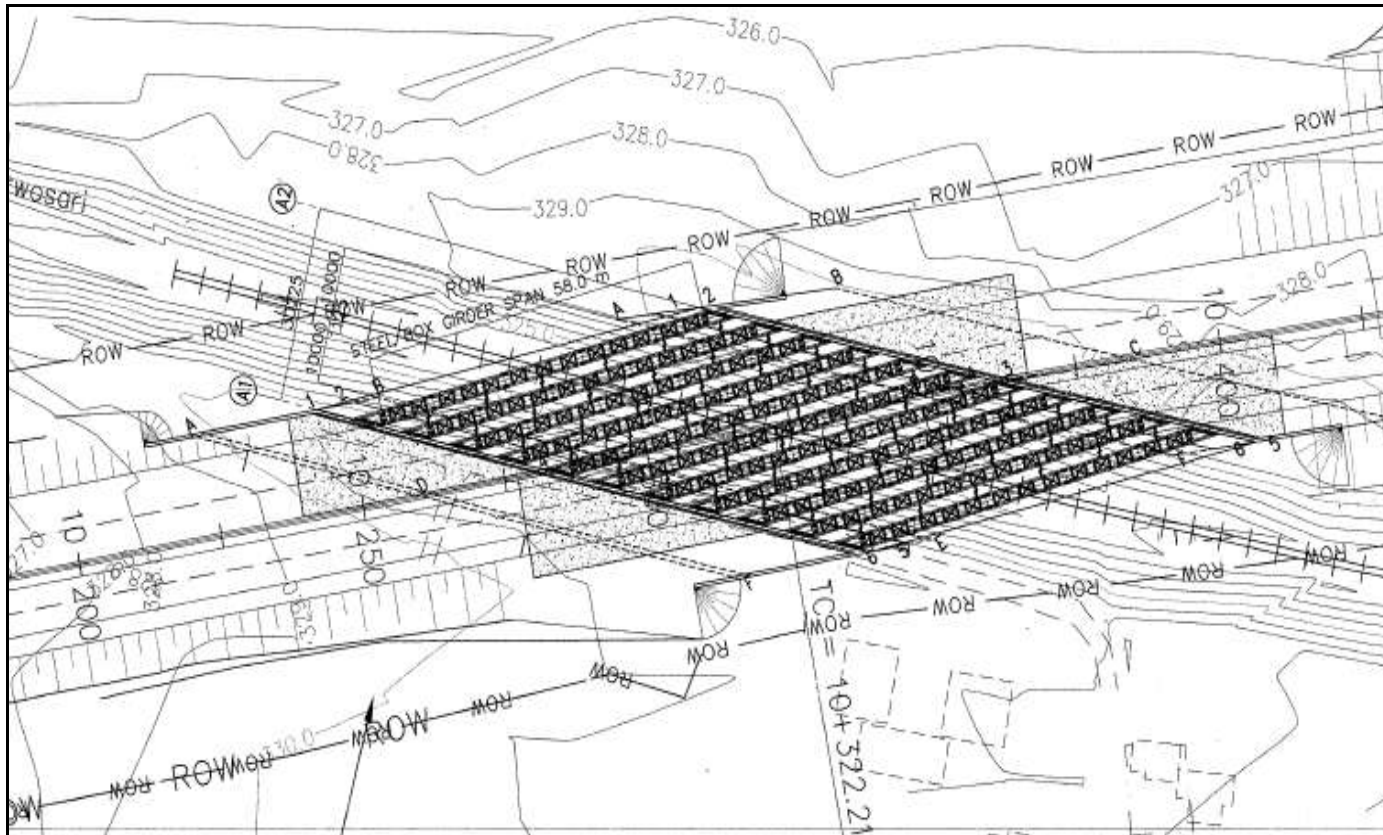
Denah Konfigurasi Bore Pile STA 10+300
